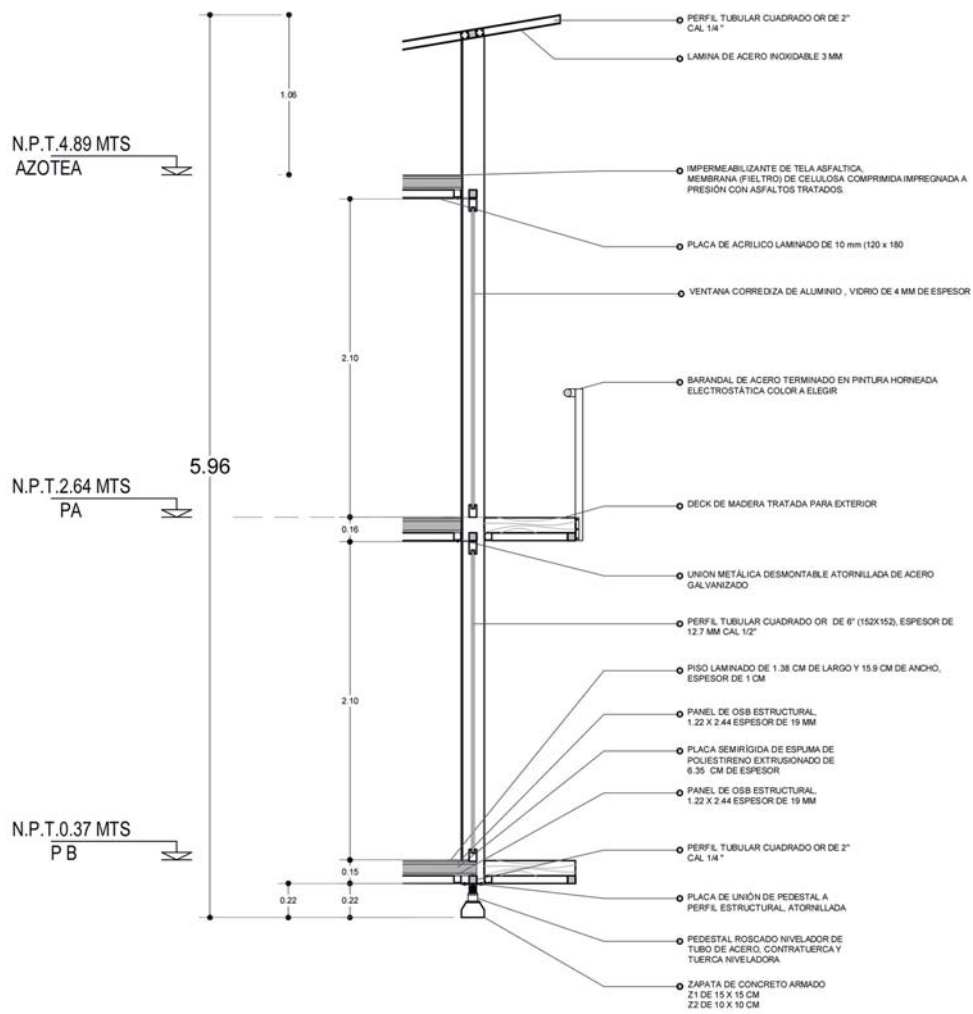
Nelly Hernandez (2018) Albañilerías muros (plano).
